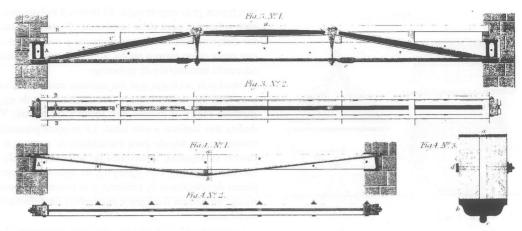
Ejemplo de viga armada de Krafft (Newlands 1860)
